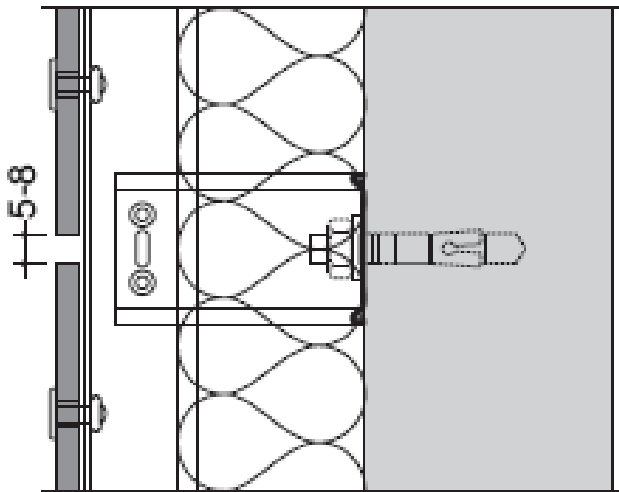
Coupe verticale sur joint horizontal (joint ouvert)
